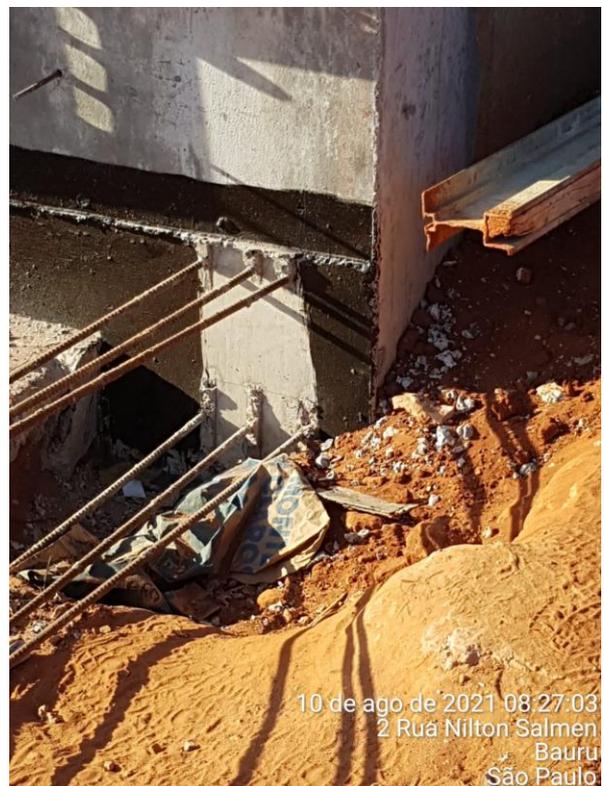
Presença de ferragens expostas na estrutura. (Data da imagem: 10/08/2021)
